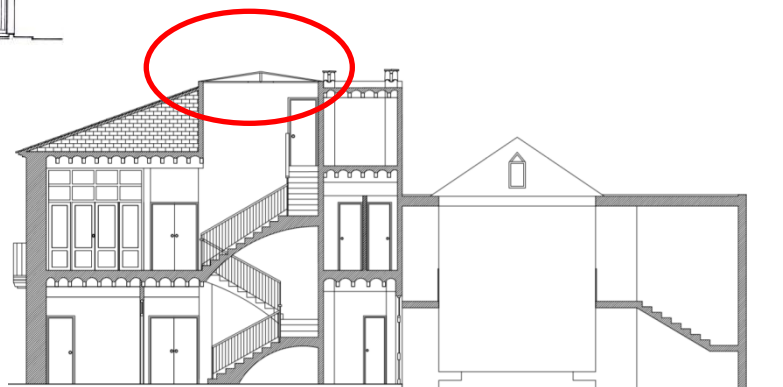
Plano sección longitudinal. Fuente: Elaboración propia, creación 28/06/2019
